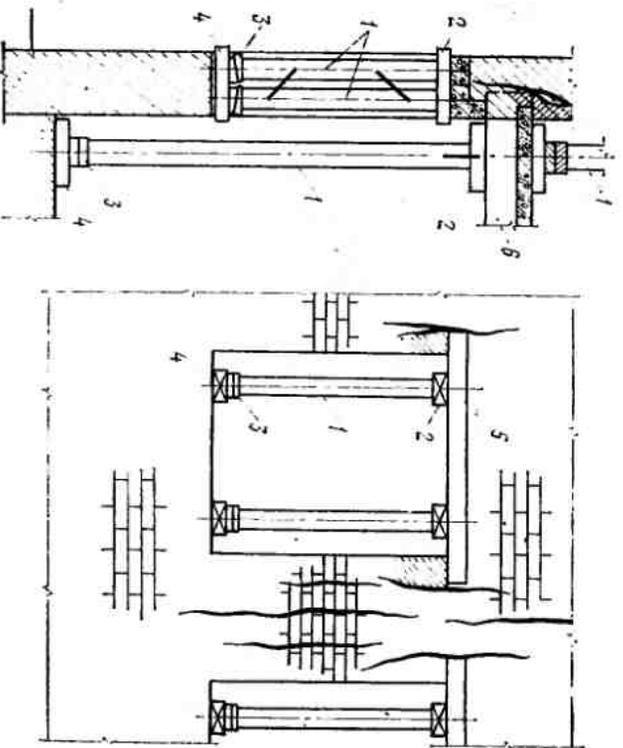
Укрепление и разгрузка от массы перекрестий поврежденных простенков стойками
